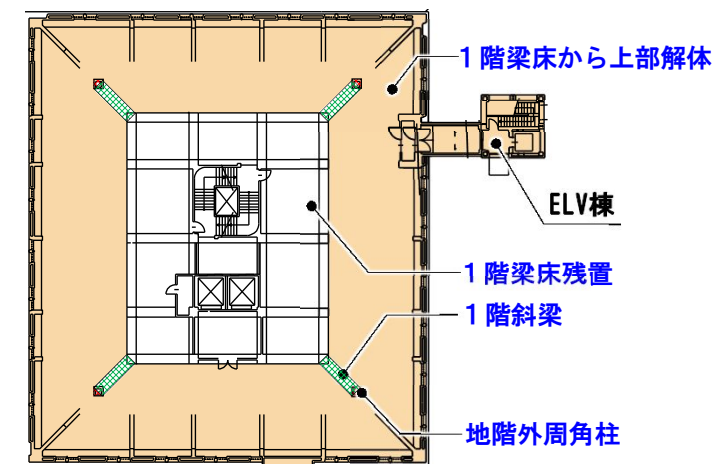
大天守解体部分1階平面図(ELV棟含)
